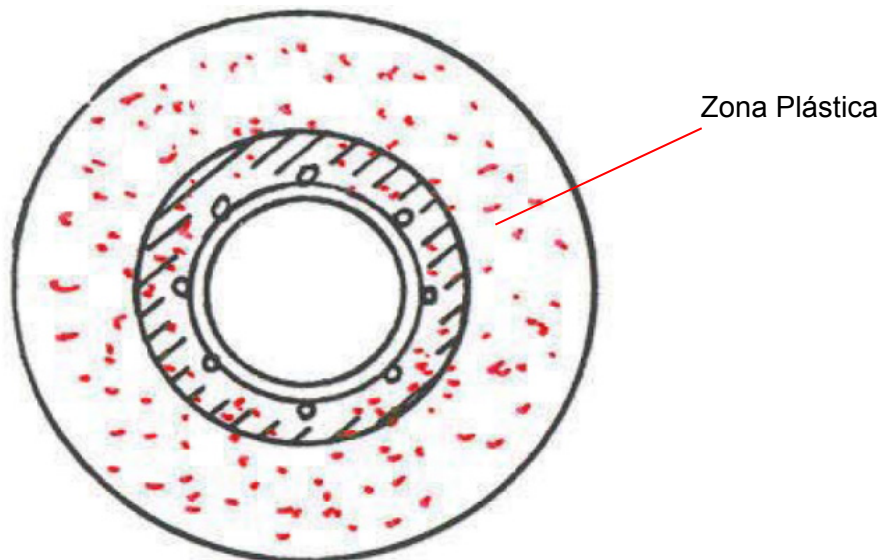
Túnel con drenaje e inyecciones de consolidación.
